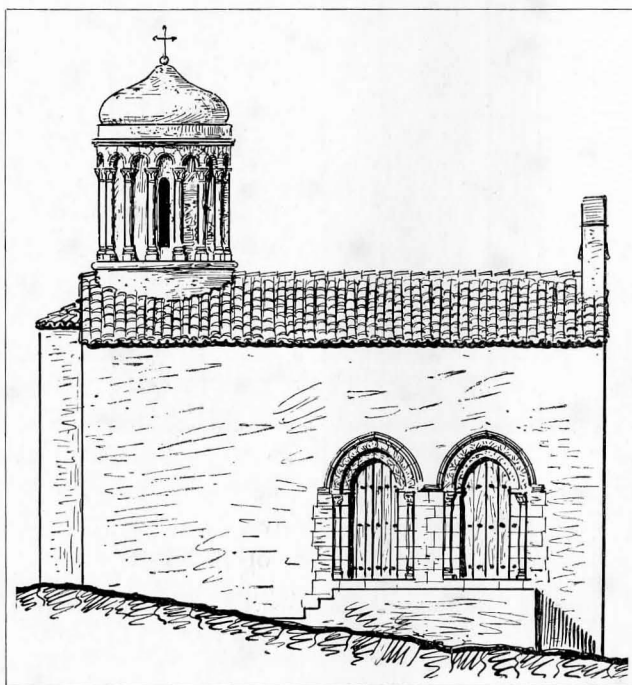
SANTA SEVERINA, CHIESETTA DI SANTA FILOMENA - PROSPETTO LATERALE
